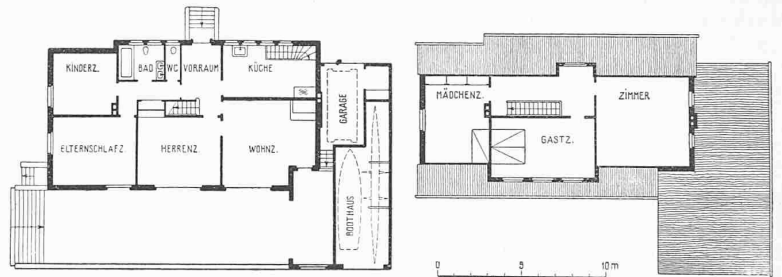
und 2. Grundrisse von Erdgeschoss und Dachgeschoss. — Masstab 1:400.
